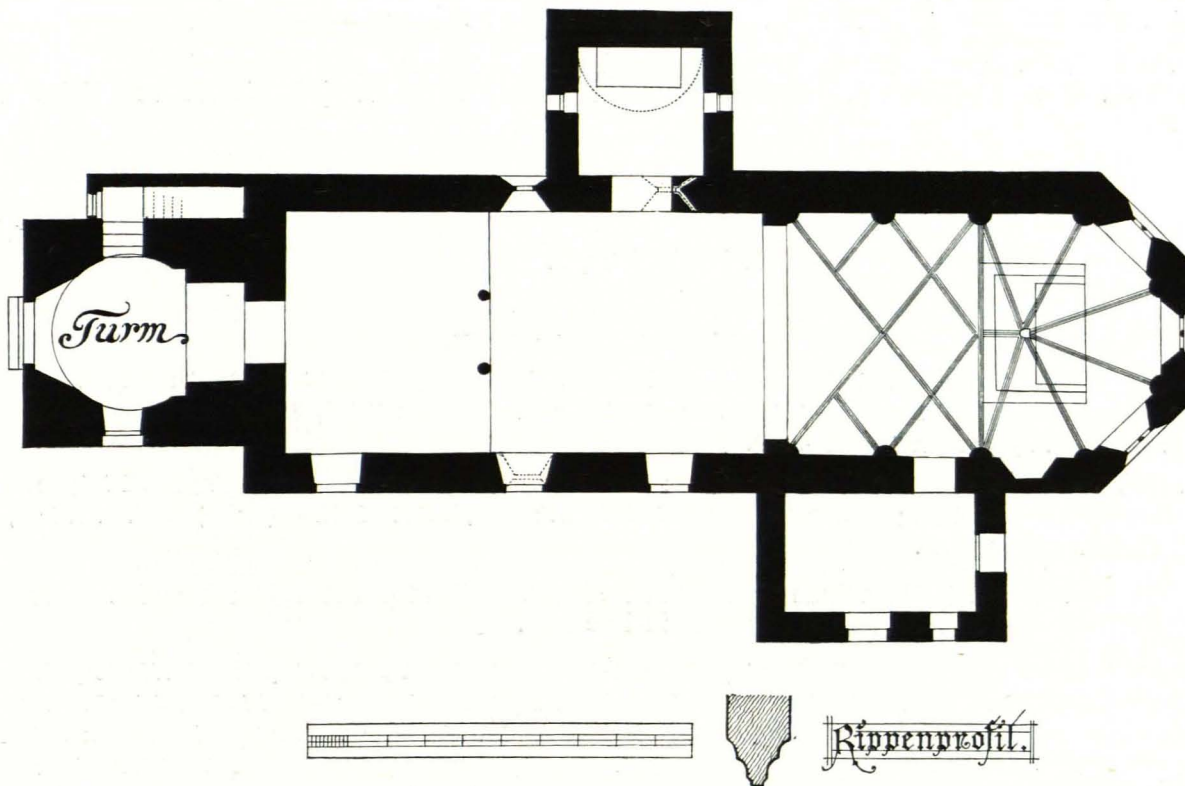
Laimbach, Pfarrkirche, Grundriß 1:200 (S. 58)
